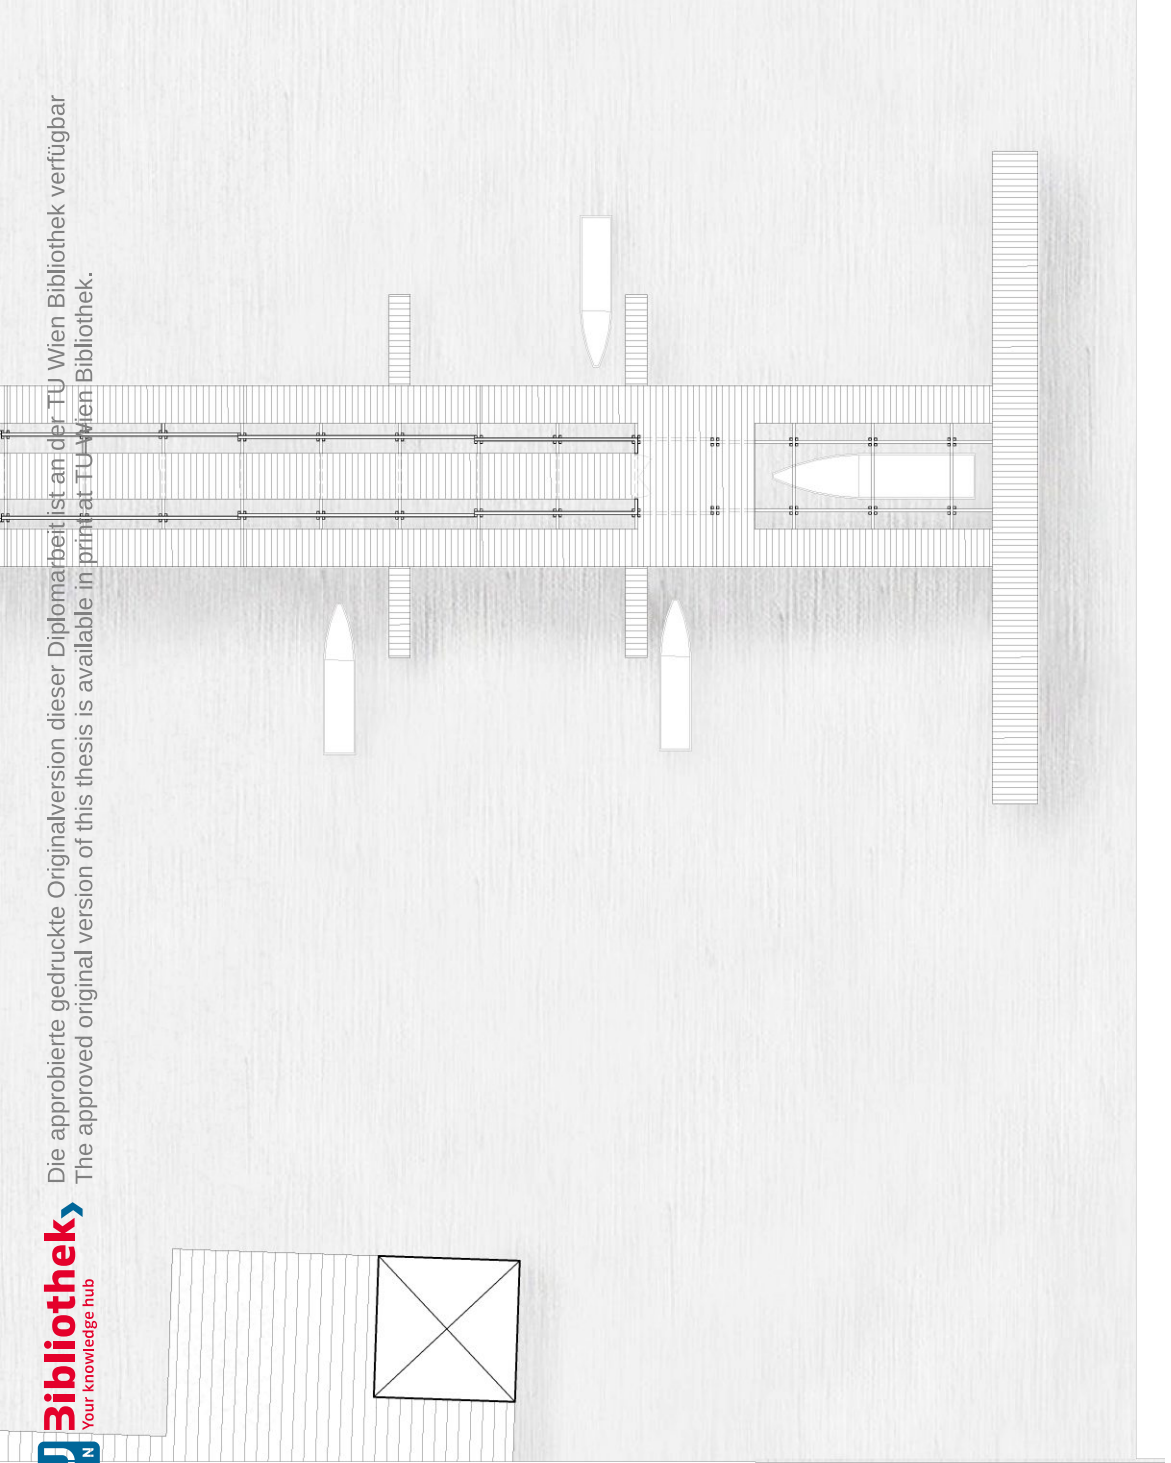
| Grundriss Erdgeschoss. M1:250.
